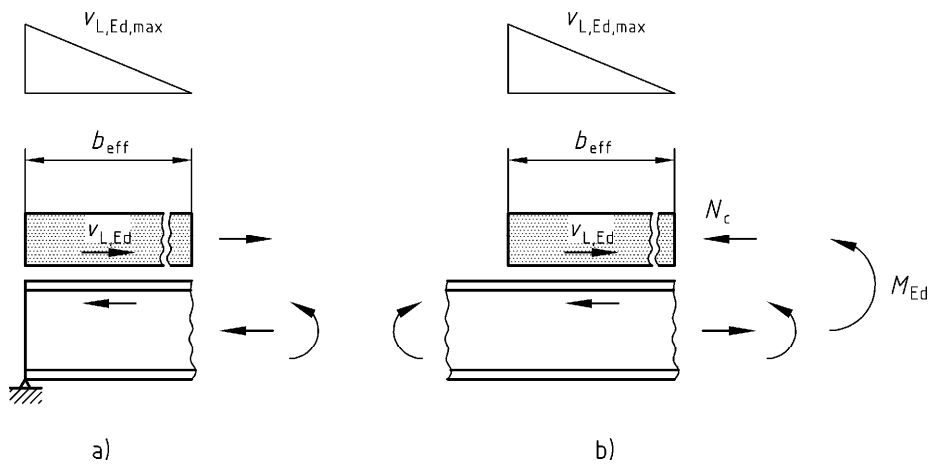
Verteilung der Längsschubkräfte an Betongurtenden
